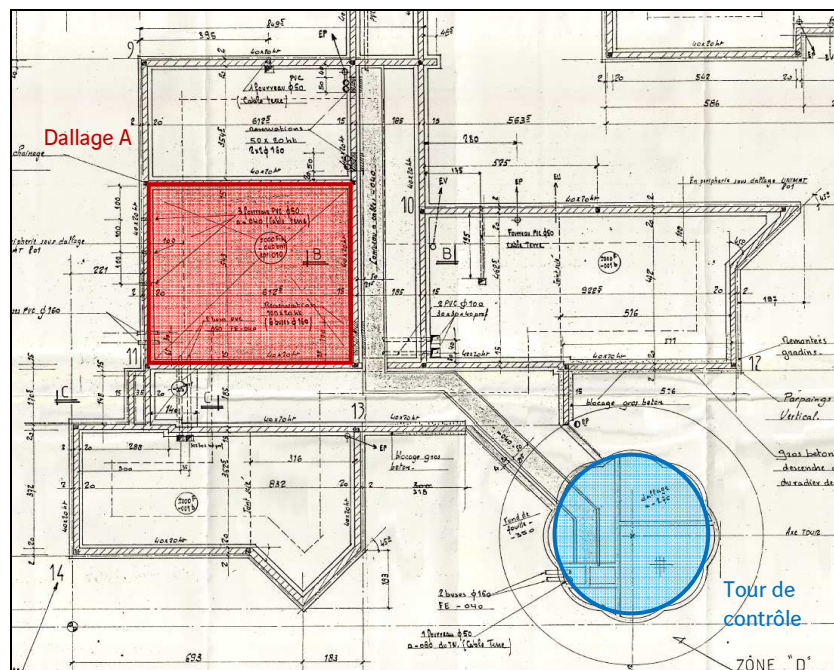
Vue en plan du dallage A – Extrait Plan 100° Fondations_Dallage – Coffrage – 12/01/87
